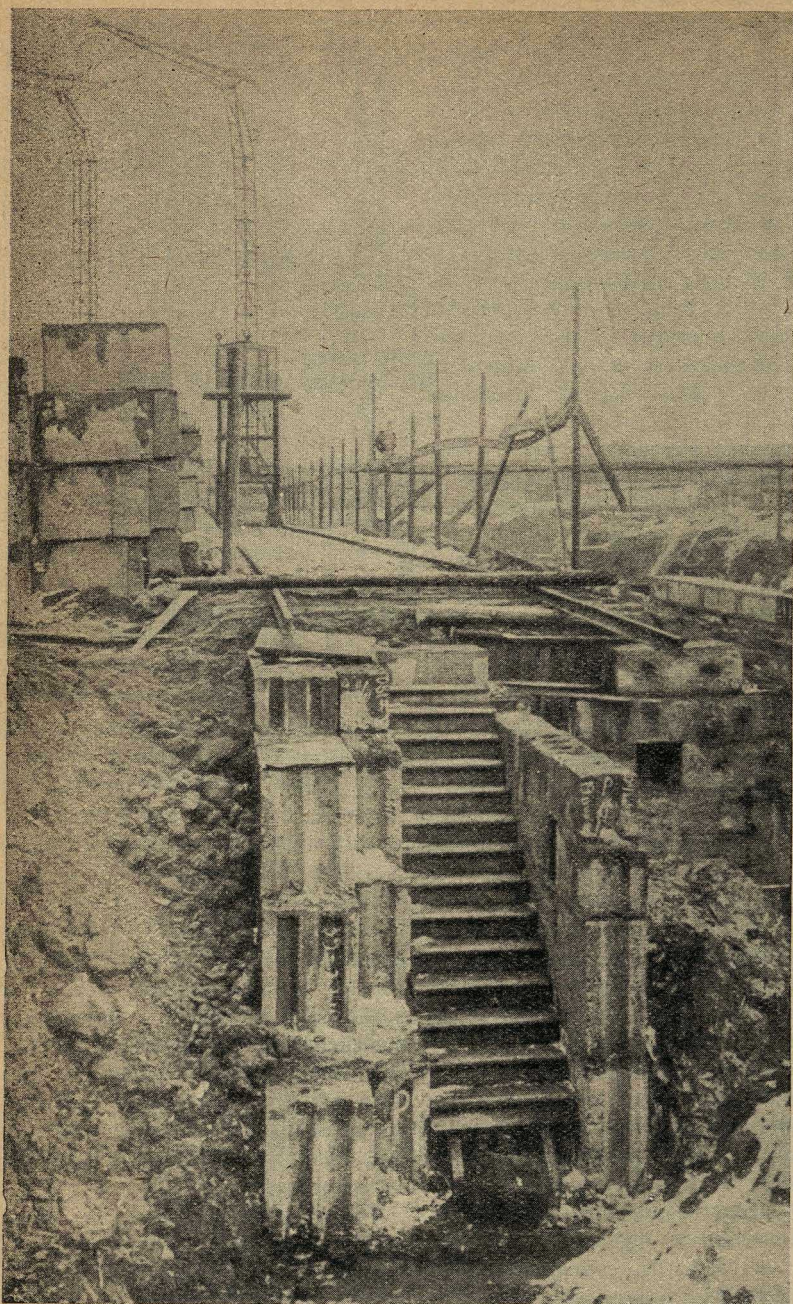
Одновременно с монтажом фундаментных стен ведется монтаж лестничных маршей, а также засыпка фундамента.
